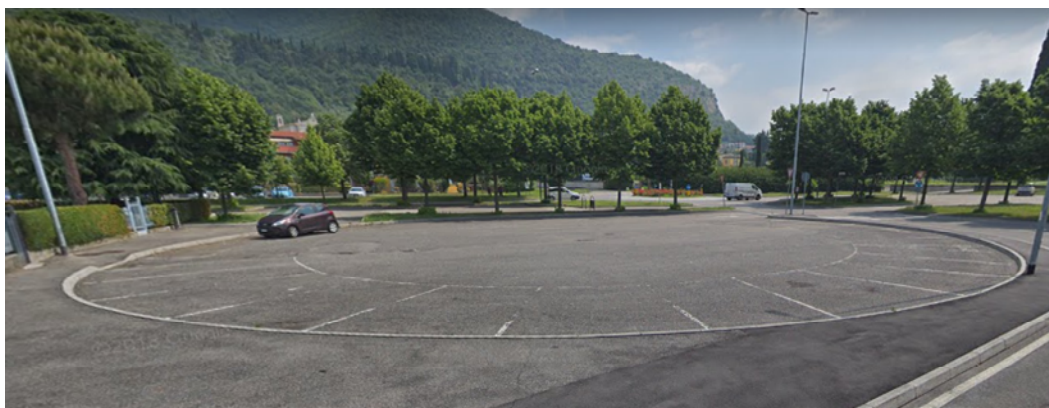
esempio di ampio parcheggio rivestito in asfalto tradizionale
